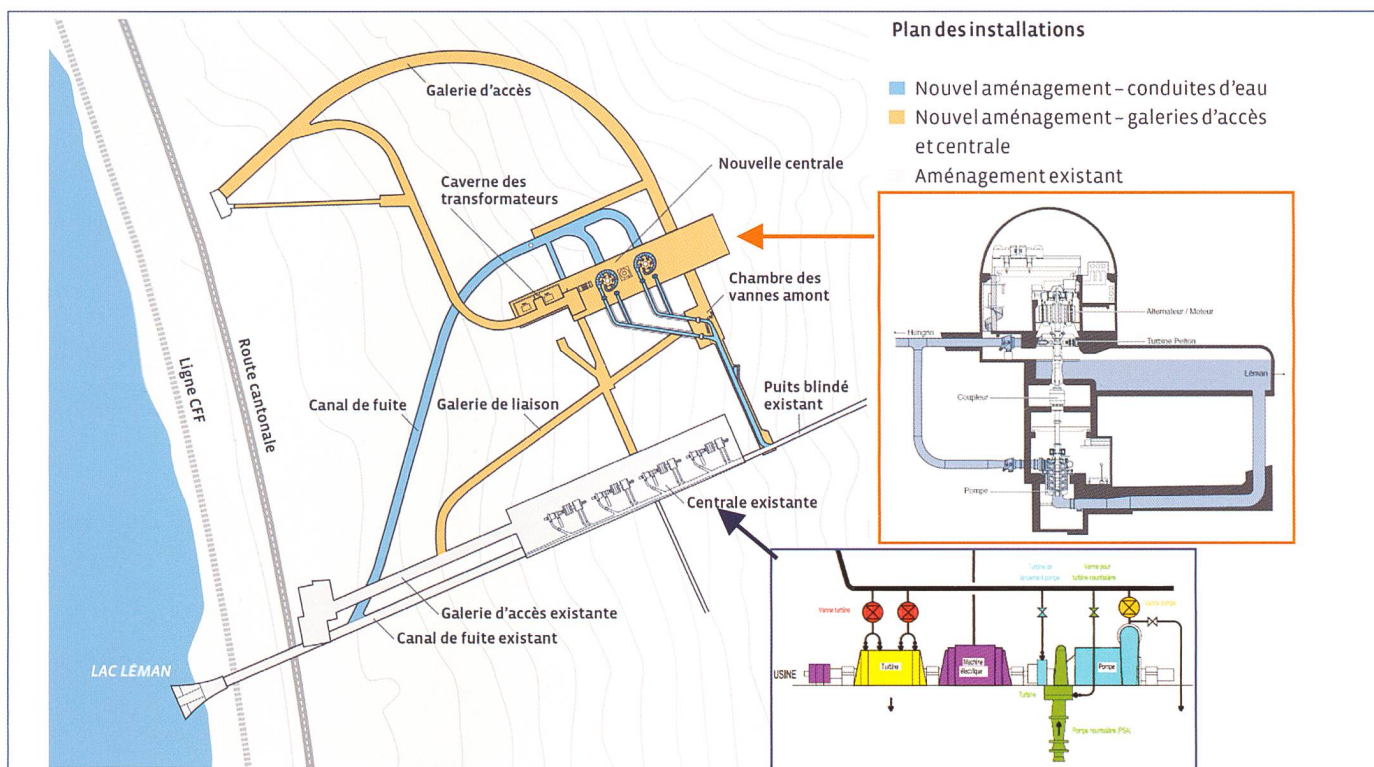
Plan des nouvelles installations souterraines avec coupe du nouveau groupe.
